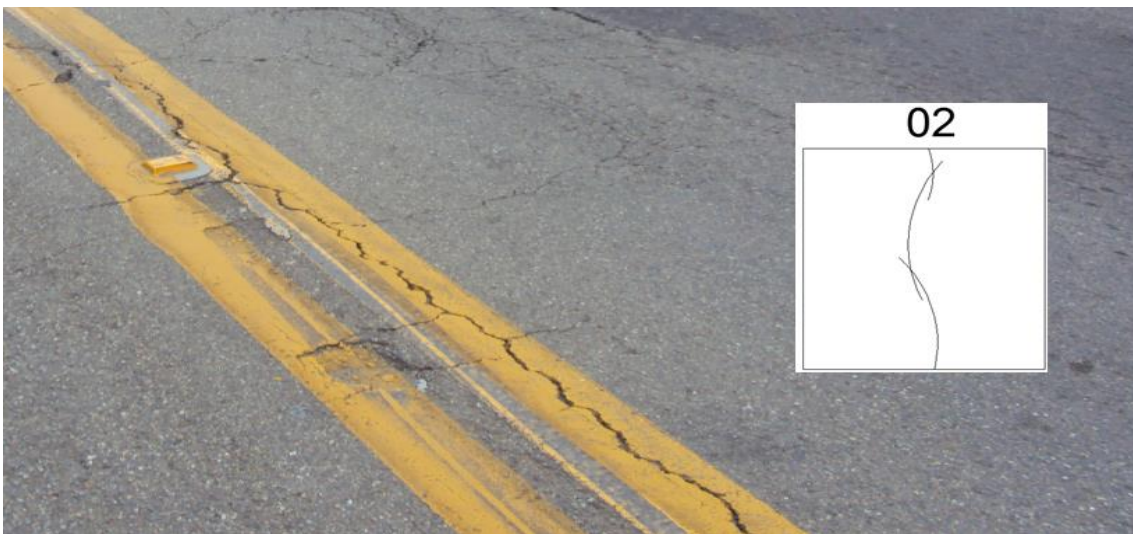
Grietas longitudinales por fatiga U.M. 331 (VIZIR).
